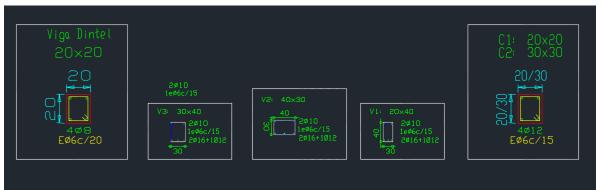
Detalle de vigas y columnas de encadenado – proyecto parque este
